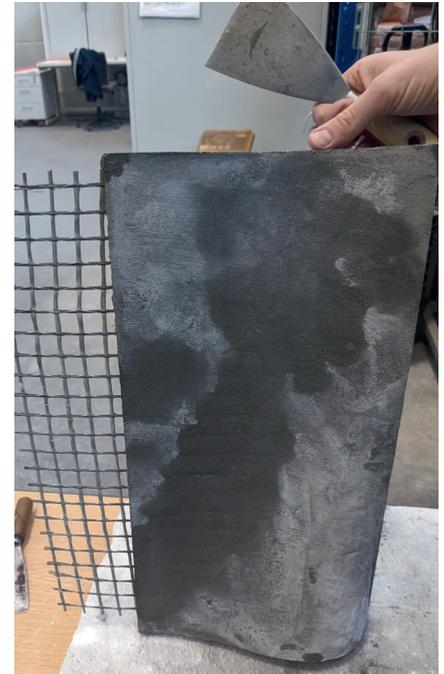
Carbonbetonbauteil nach dem Ausschalen
